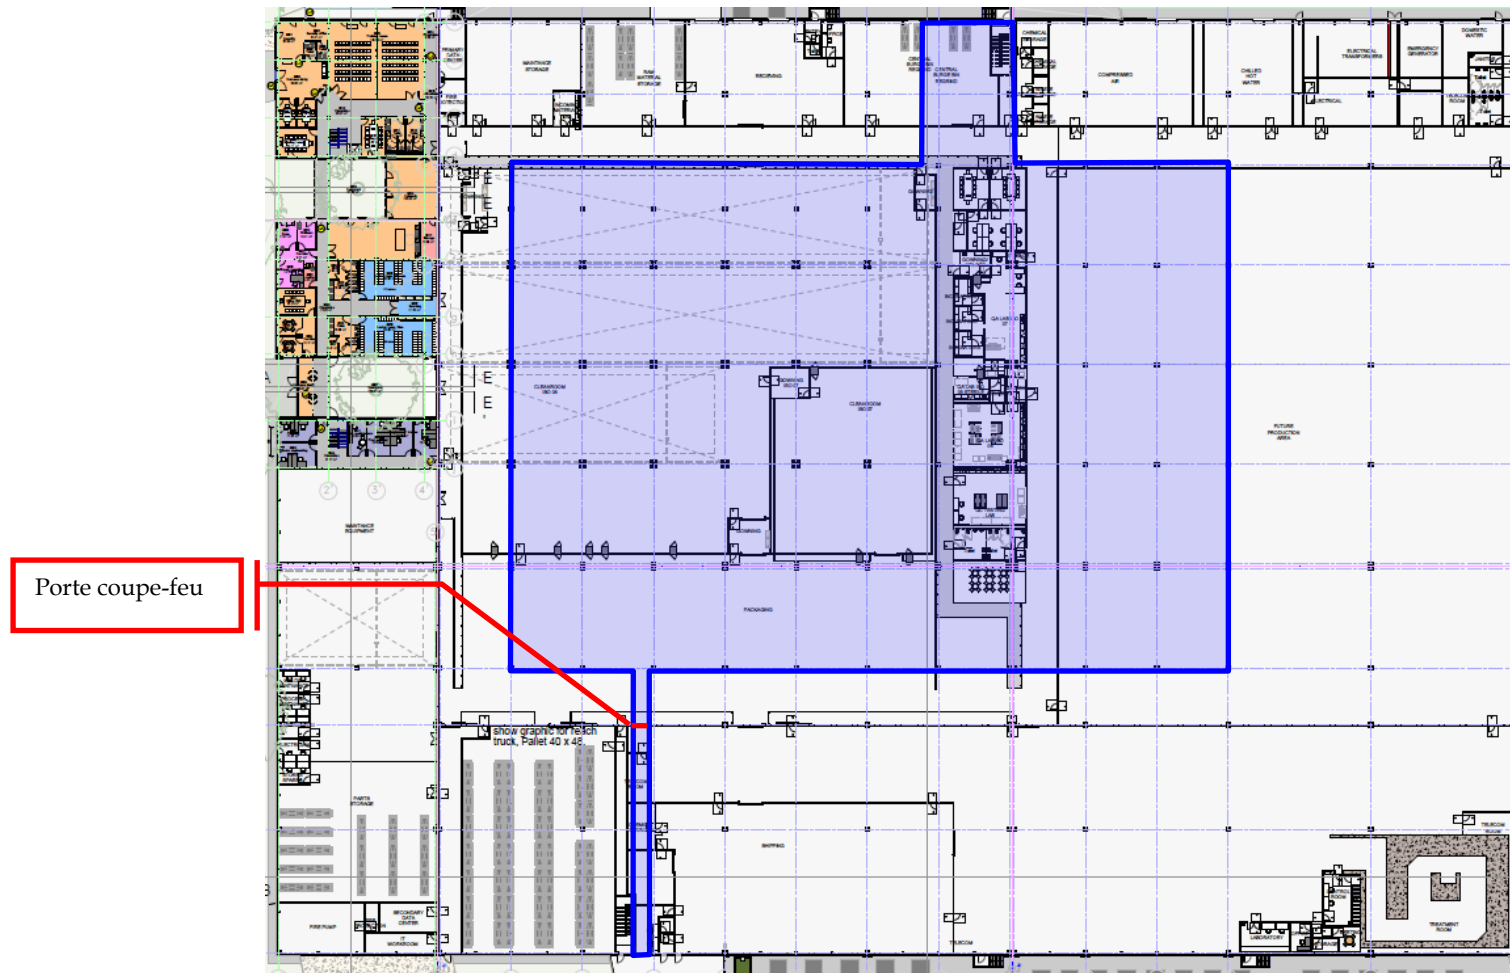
Plan du plancher technique - superposition sur rez-de-chaussée
